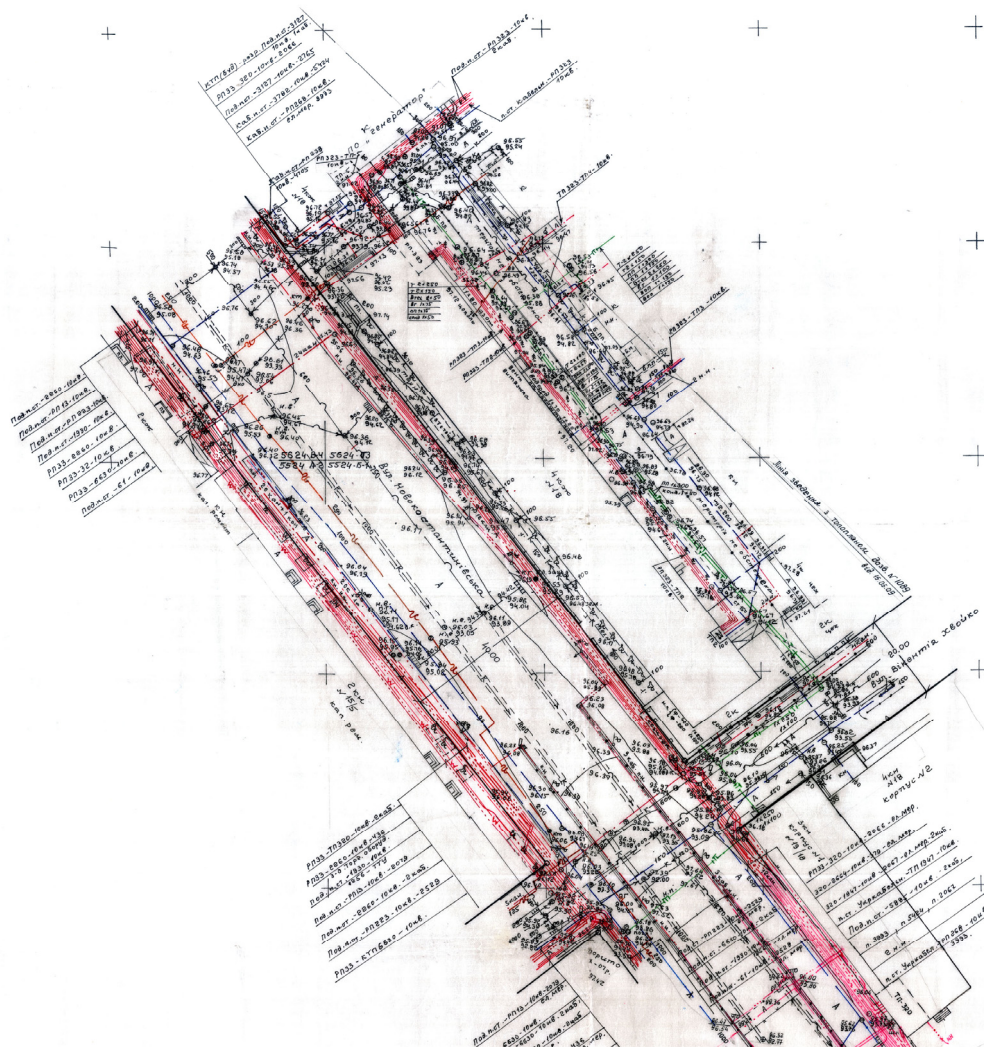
Генплан ділянки забудови офісної будівлі
